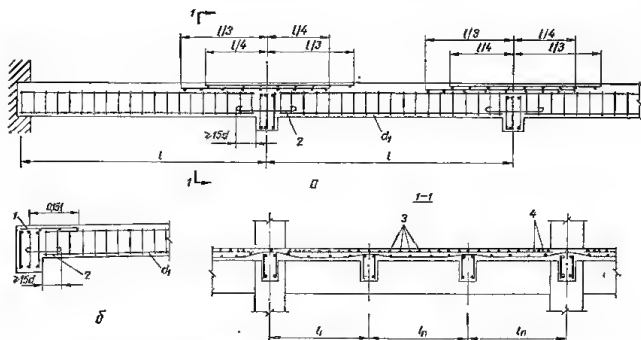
Схема армирования второстепенных балок при опирании:
